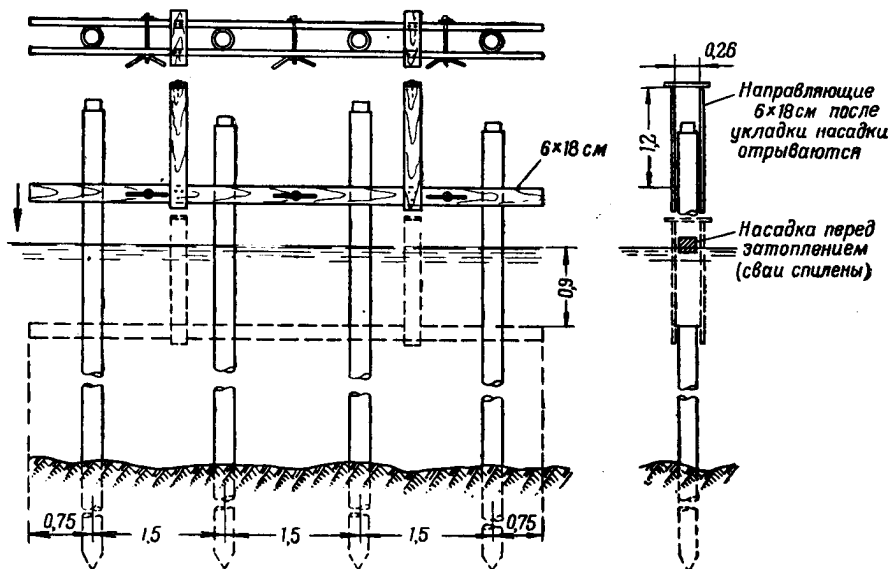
Горизонтальные схватки для выравнивания, опилки свай и укладки насадки.
